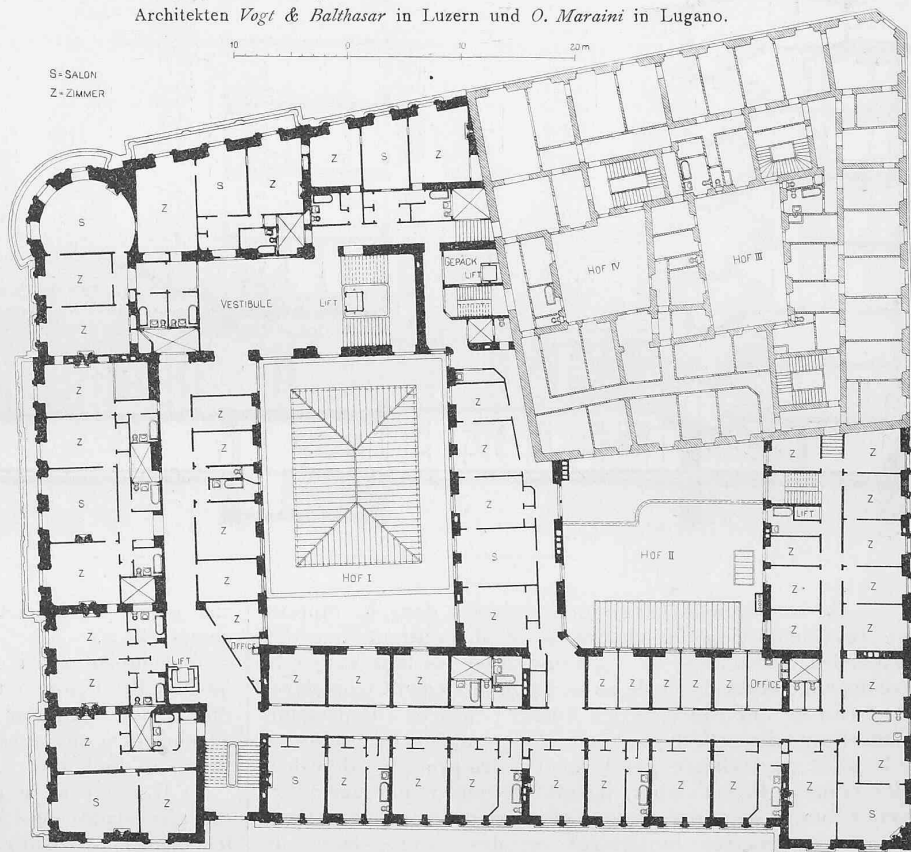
Grundriss vom ersten bis vierten Obergeschoss. — Masstab 1 : 600.
